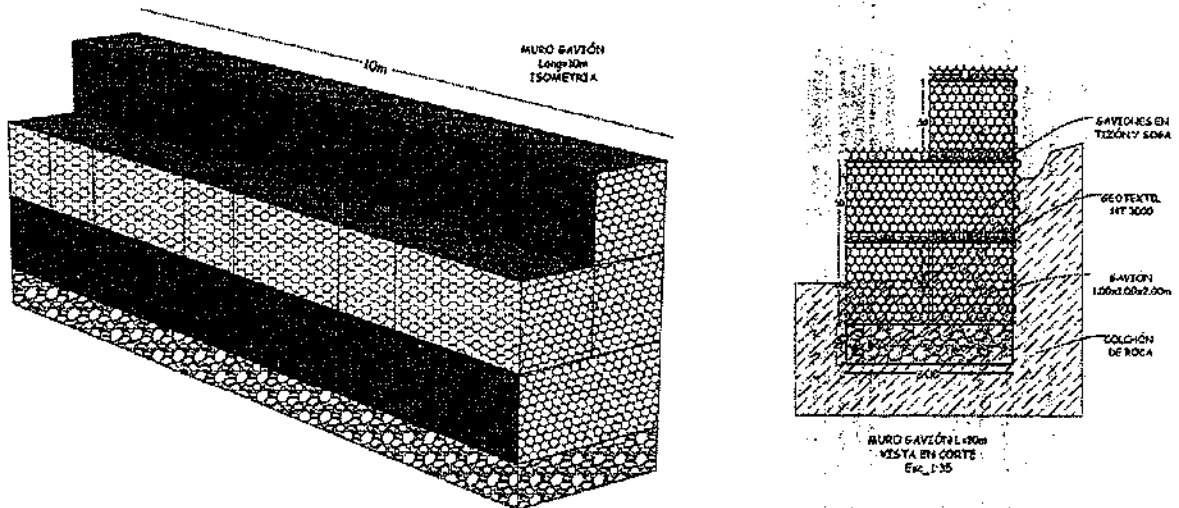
Detalle de la sección del muro de contención y su cimentación - Fuente: Consorcio Avanza Gamarra 2025.
